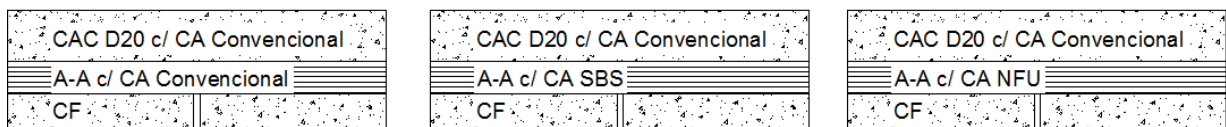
esquema de modelo 1. CAC D20: concreto asfáltico denso tmáx. 20 mm. A-A C: Arena asfalto. CA: cemento asfáltico. SBS: polímero virgen. NFU: neumático fuera de uso.
